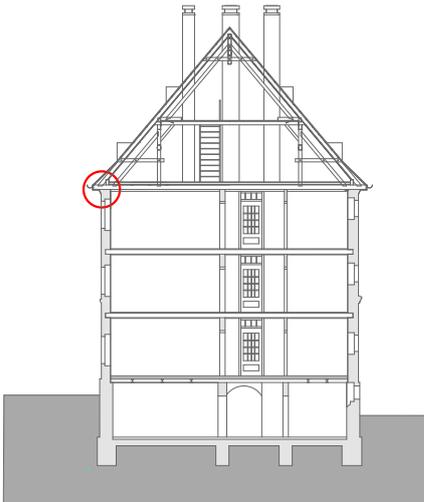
Traufdetail Bestandssanierung mit Innendämmung
